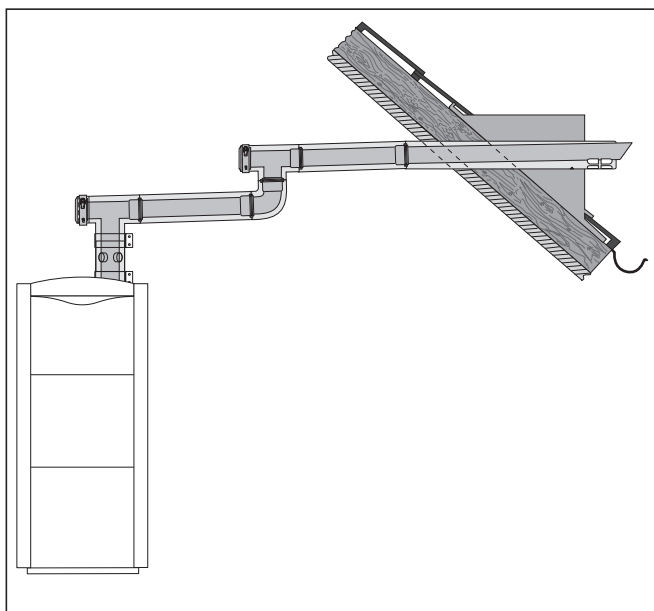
Exemple de montage d'une traversée de mur/toit horizontale avec 2 pièces en T d'inspection
